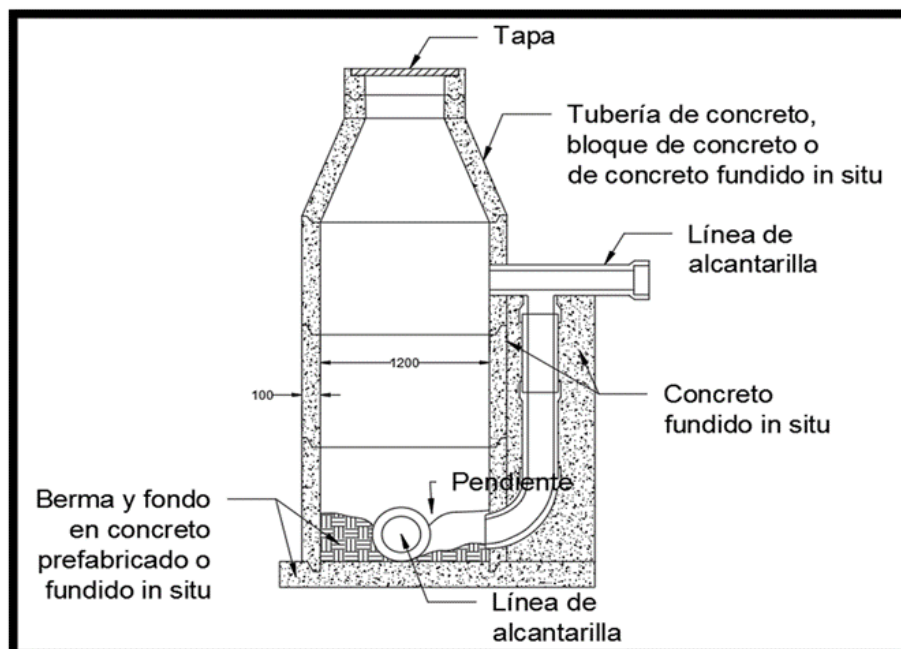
Pozo de inspección en concreto prefabricado con una entrada de caída
